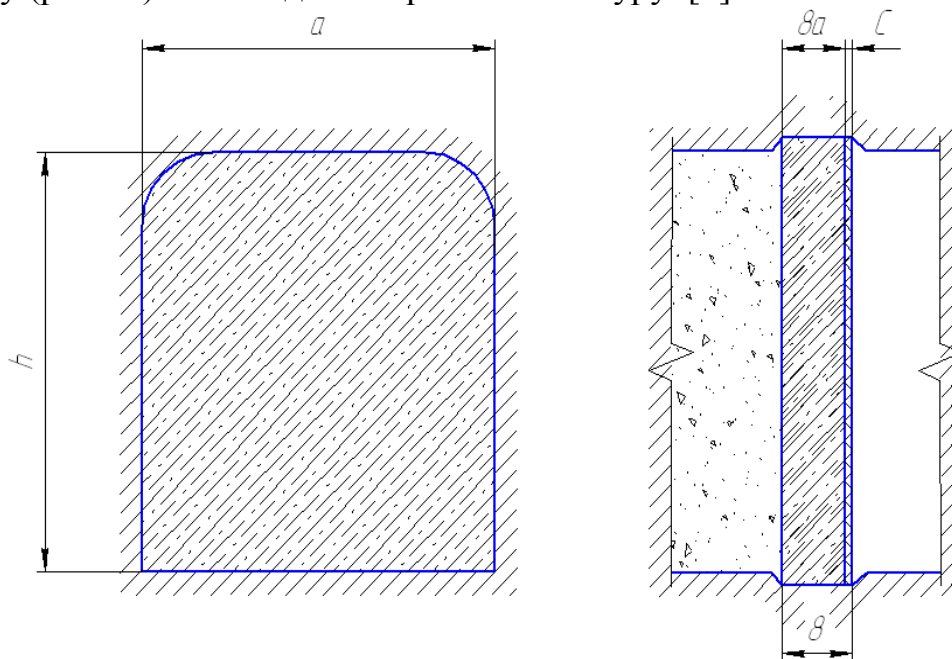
Конструкция железобетонной изолирующей перемишки, защемленной по контуру
